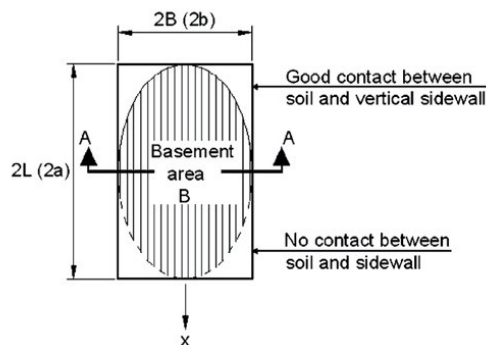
Parametri geometrici della fondazione necessari al calcolo delle impedenze
